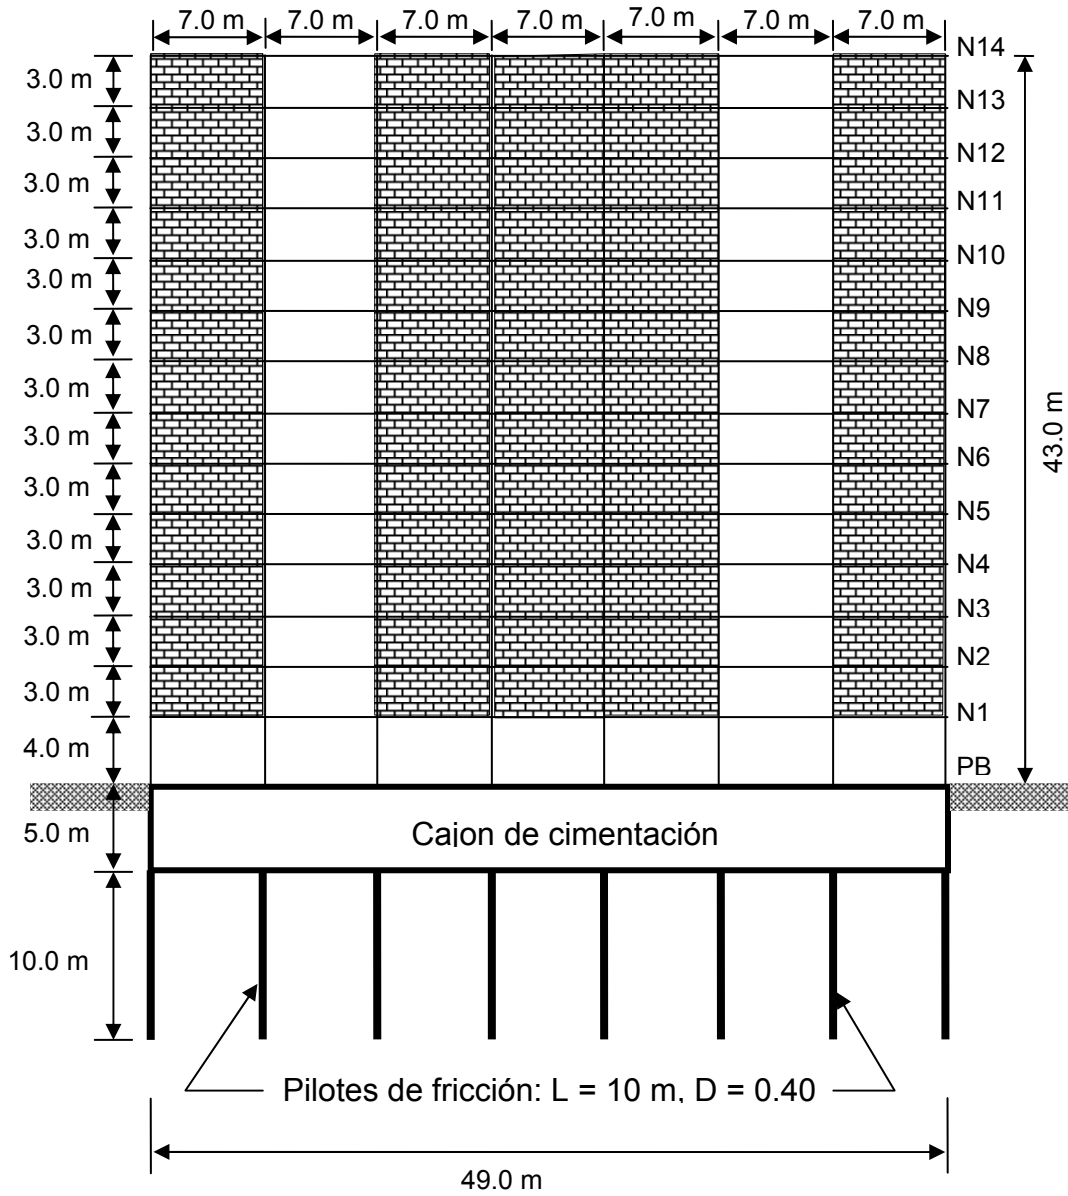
Vistas en elevación (corte a-a) de la estructura de 14 niveles
